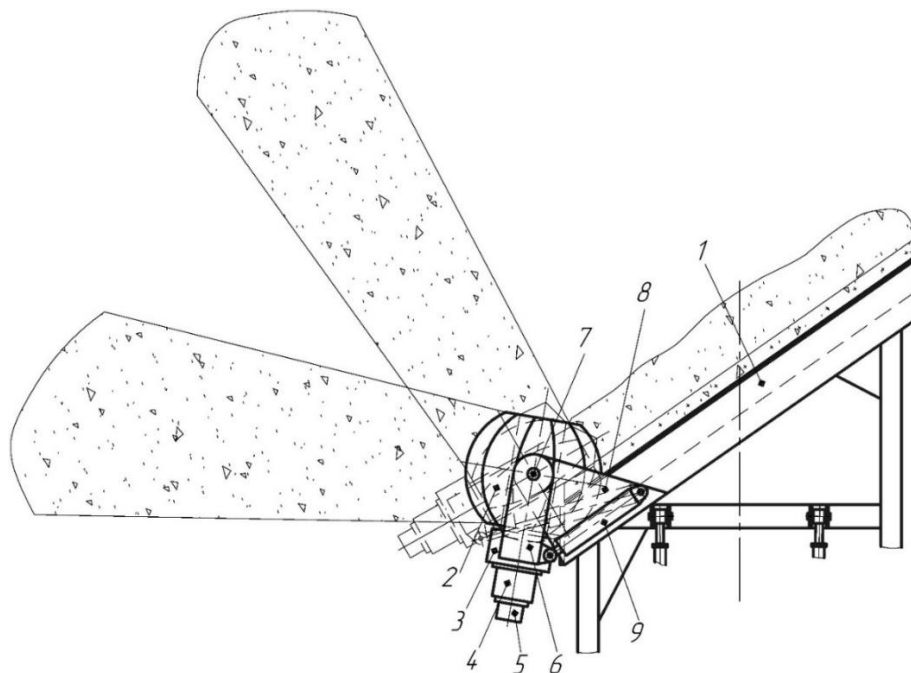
Косовстановлений відвальний робочий орган із лопатевим сферичним метальником для керованого бічного транспортування ґрунту
